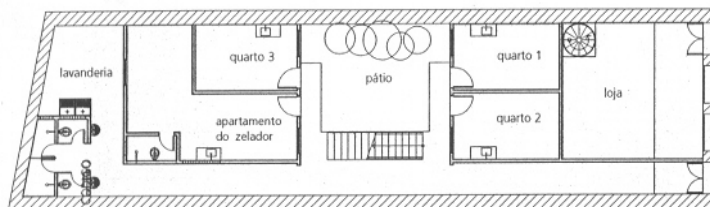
Cortiço na rua Sacadura Cabral, 295 – Planta baixa do térreo (SECRETARIA, 2000, p. 24).
